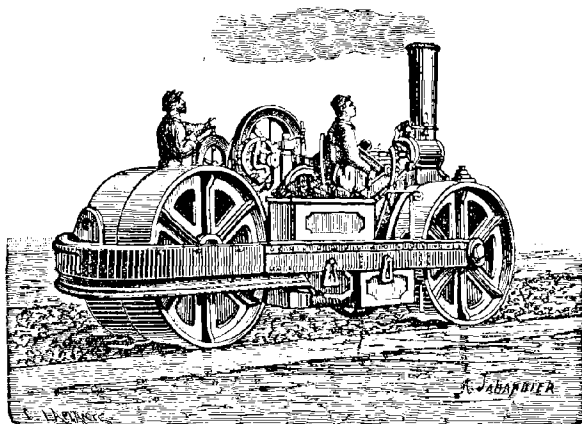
Rouleau-compresseur du macadam à vapeur.
